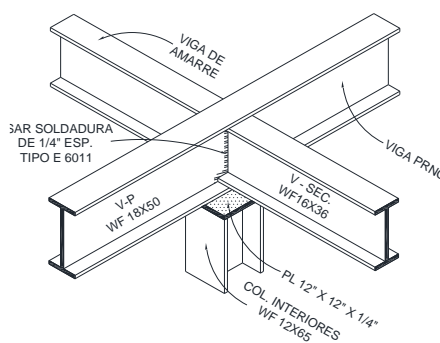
Configuración típica de conexión viga-vigueta con soldadura.
